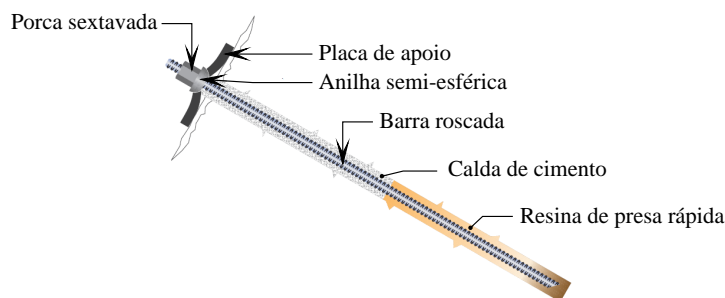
Pregagem selada com calda de cimento e resina de presa rápida (adaptada de DYWIDAG, 2006a).
